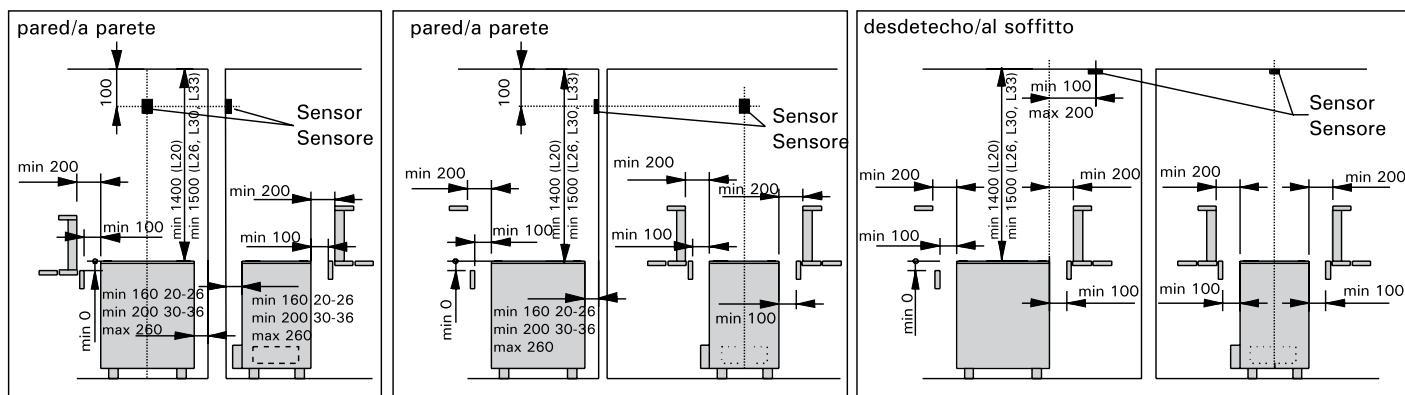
Instalación de la caja del sensor del centro de control (C260) y de las estufas (L20-L33)
